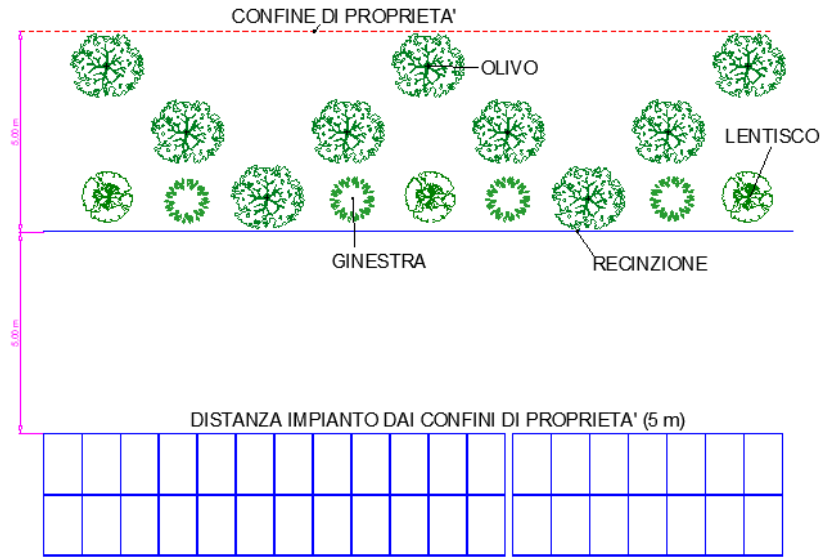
Opere di Mitigazione (Vista in Pianta fascia stradale)
